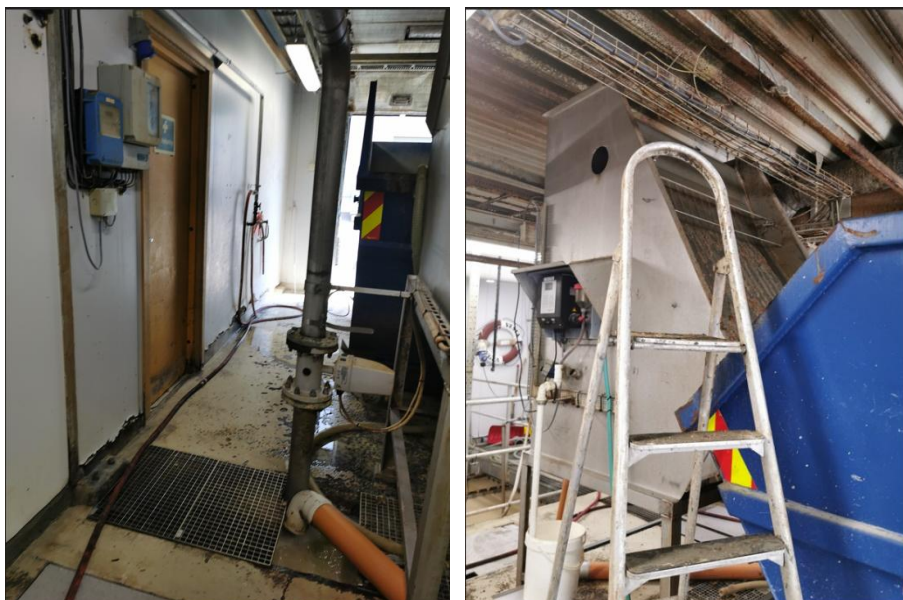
Plan 1 av dagens rensanlegg. Bassenger under bakkeplan.
